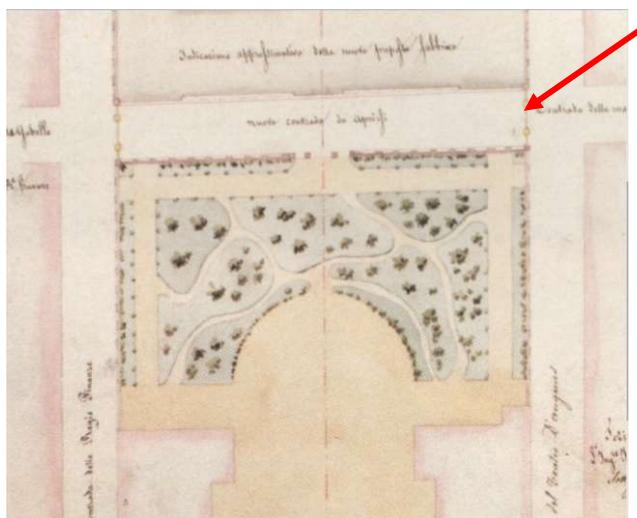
Planimetria del palazzo e progetto di nuova costruzione, 22 Febbraio 1833, ASTR, Tipi annessi alle Patenti, sec. XIX, 572; da: M.G. Cerri, Palazzo Carignano. Tre secoli di idee, progetti e realizzazioni, Torino, 1990. La freccia rossa indica la struttura simile a quella rinvenuta
